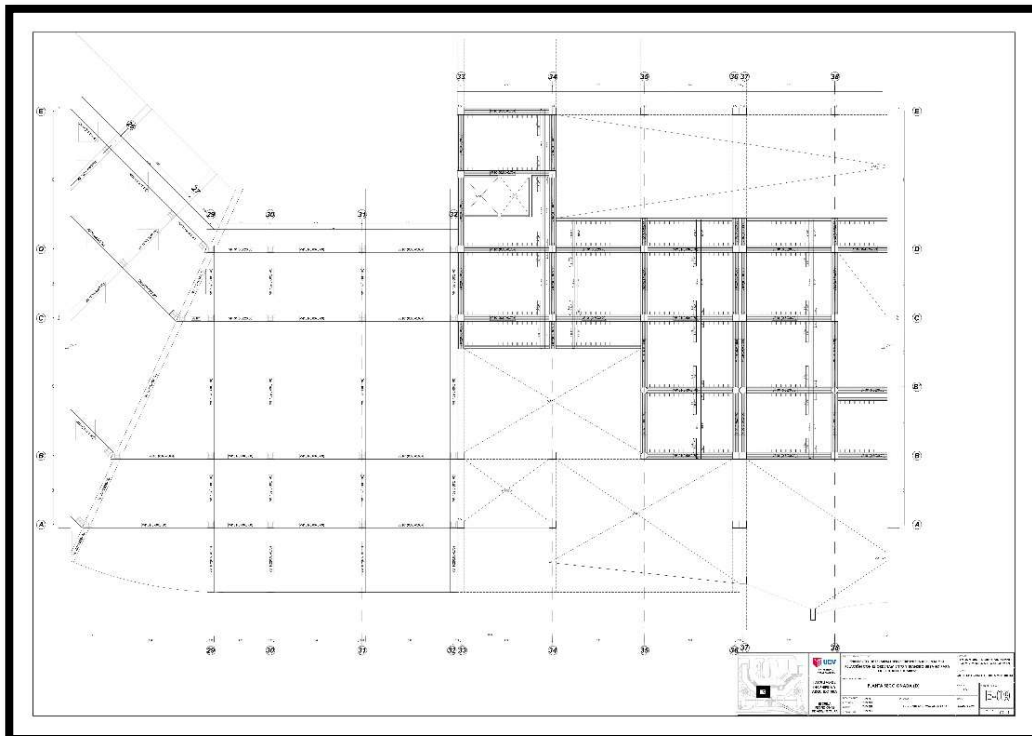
Plano de Losa Aligerada Sector (D) Fuente: Elaboración Propia.
